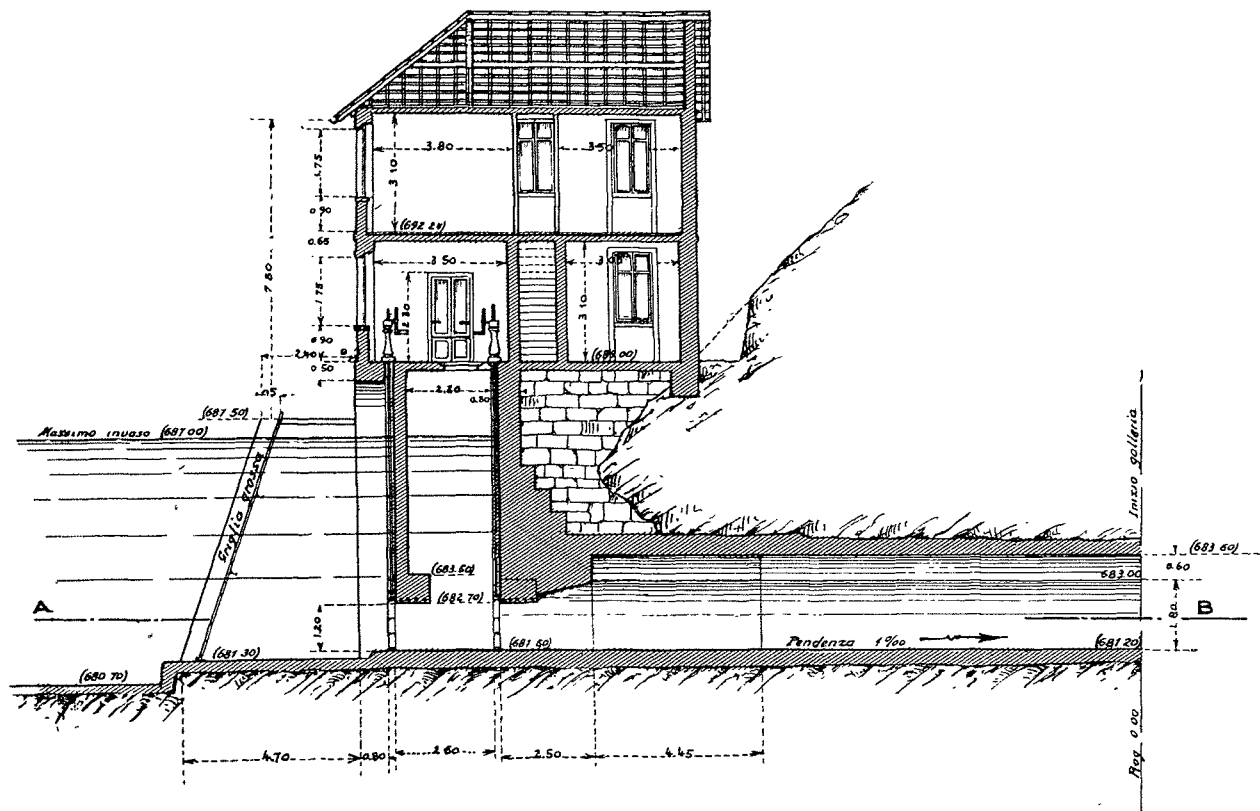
Prise d'eau : Coupe longitudinale sur l'axe de la galerie d'amenée
